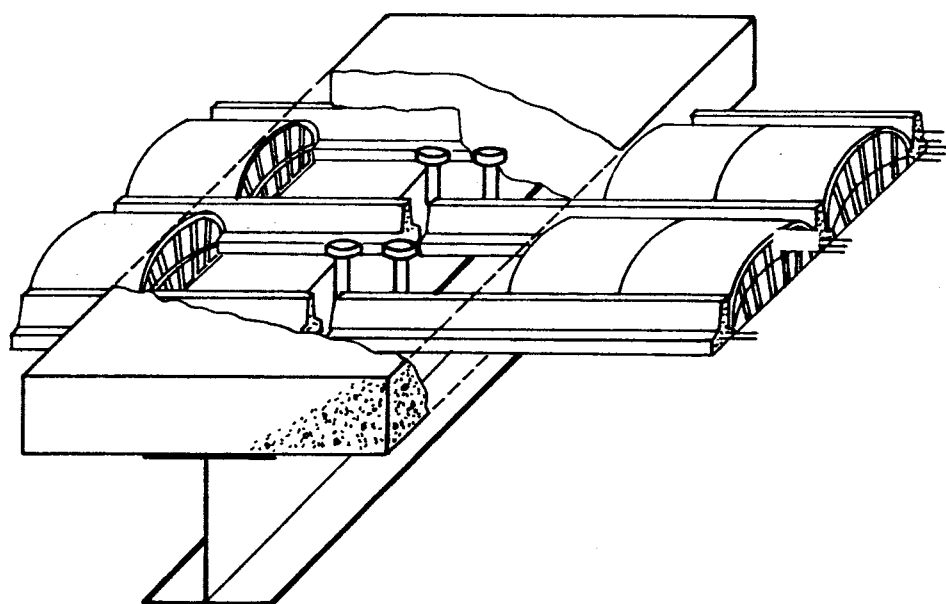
PAVIMENTO MISTO FORMADO POR LAJE DE VIGOTAS PRÉ-FABRICADAS
